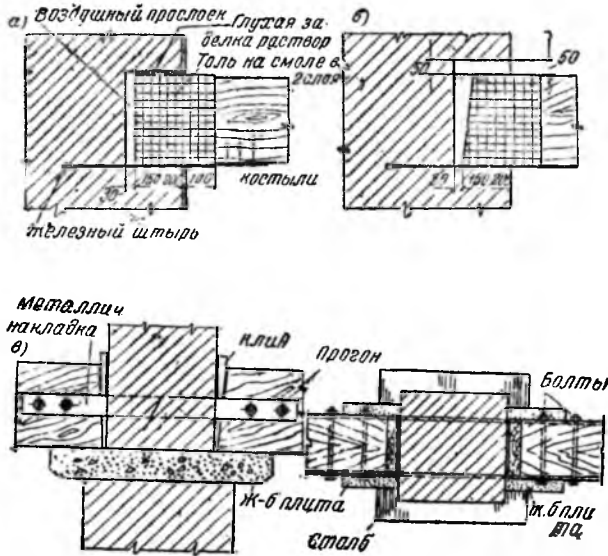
Заделка деревянных балок в стены и опирание прогонов на столбы
